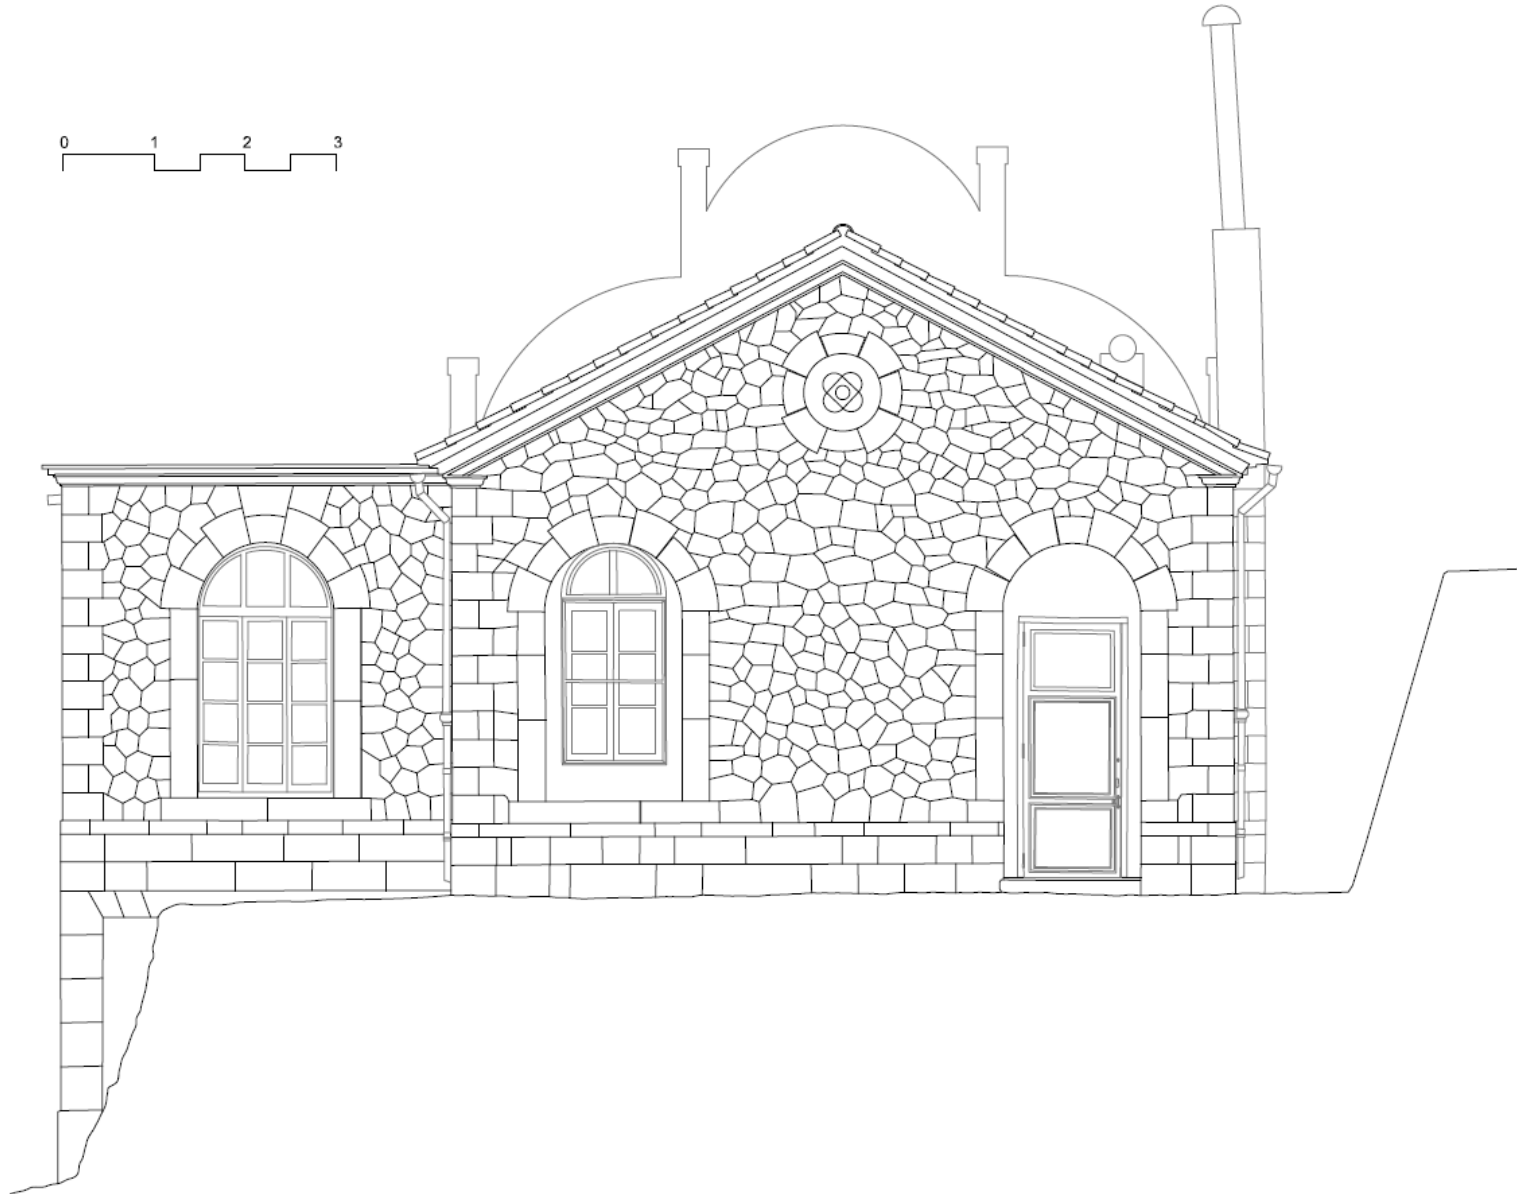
Alzado fachada posterior Norte. Levantamiento planimétrico.
